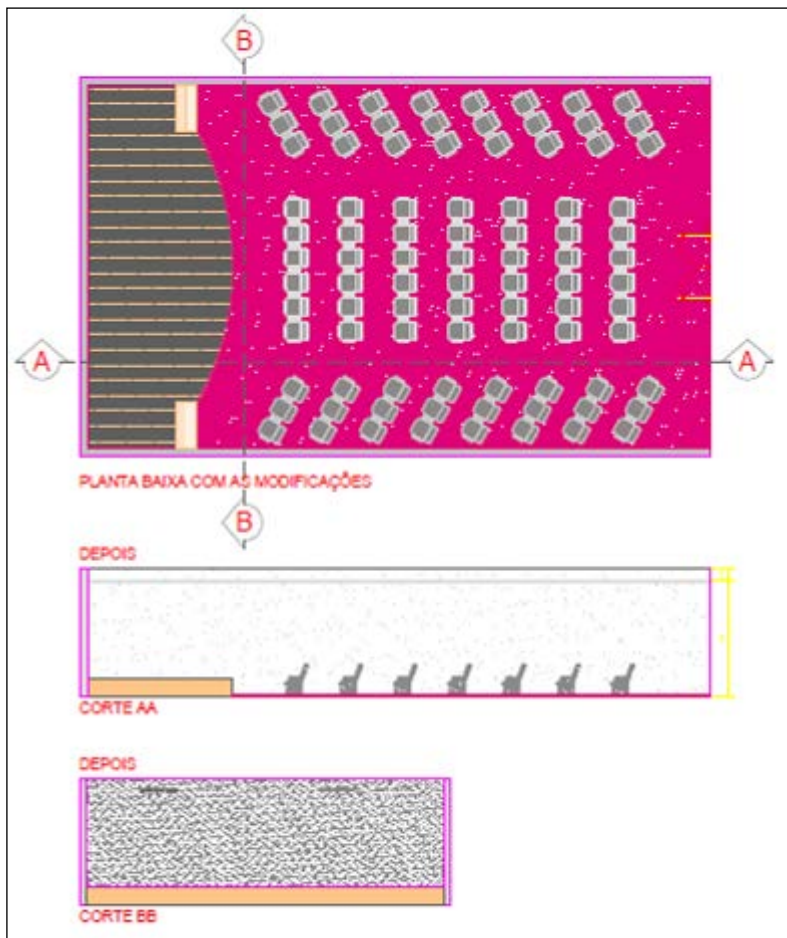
Planta baixa do forro do ambiente modificado avaliado
